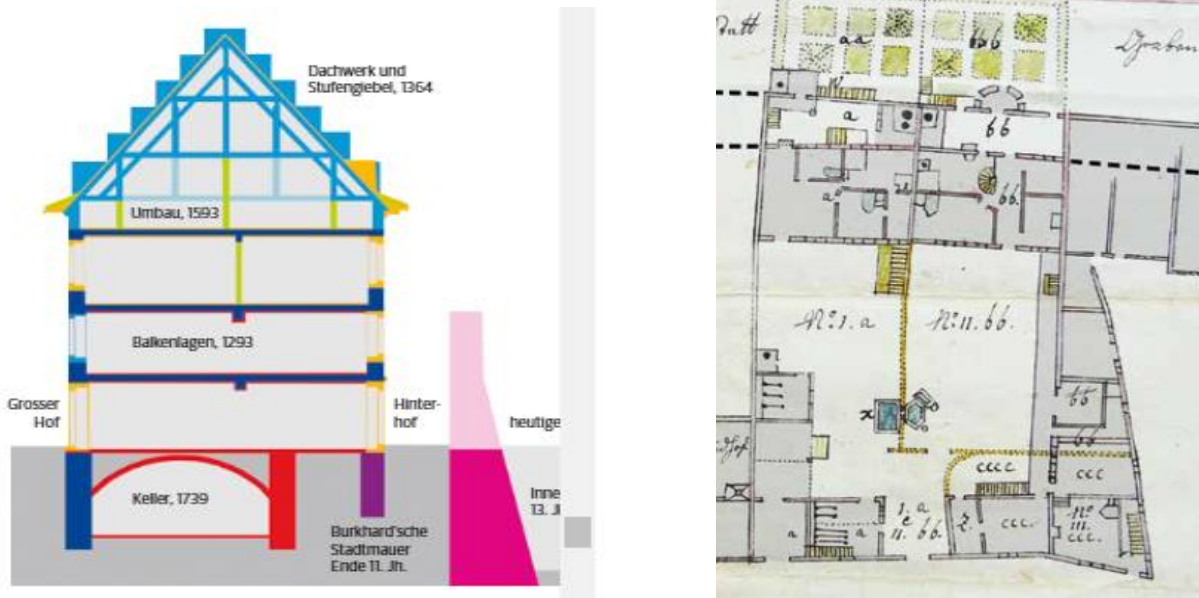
Coupe et plan du Kohlenhof à Bâle. 2017, Kantonale Denkmalpflege Basel-Stadt, pp. 64-68.
